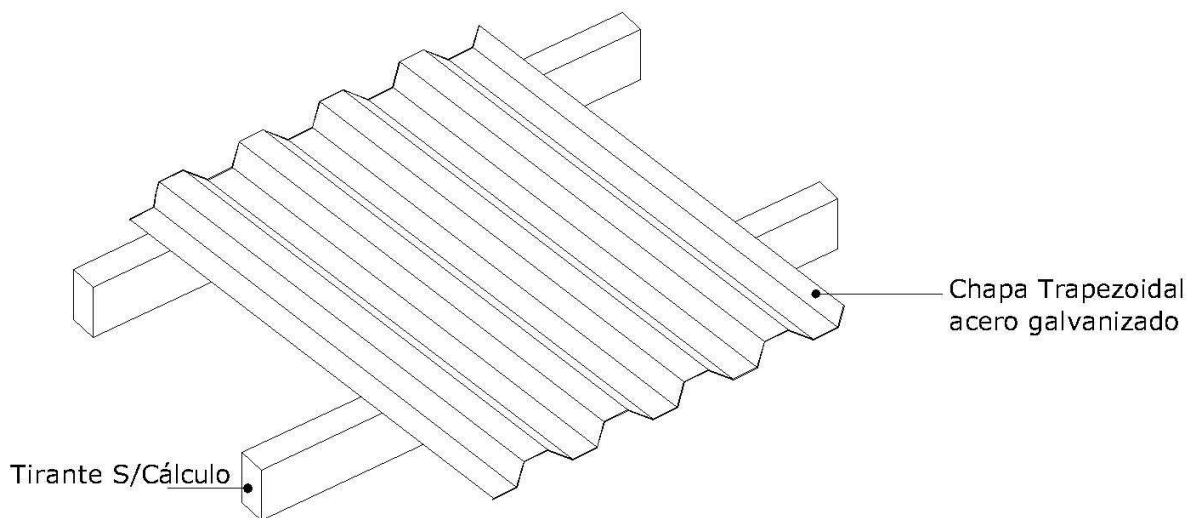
Cubierta de chapa galvanizada trapezoidal tipo T-98, montada sobre tirantería de madera sin aplicación de aislamiento o cielorraso alguno.
